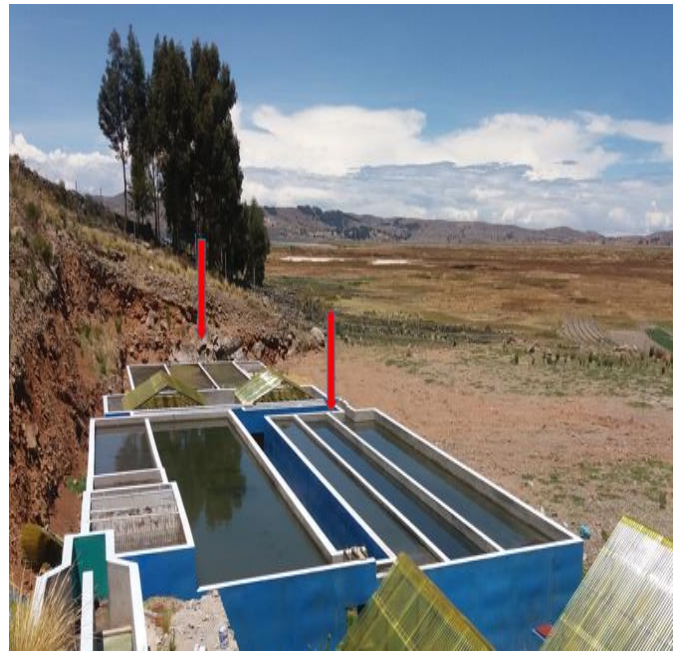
Tratamiento primario y secundario de la planta 2 – Sur
